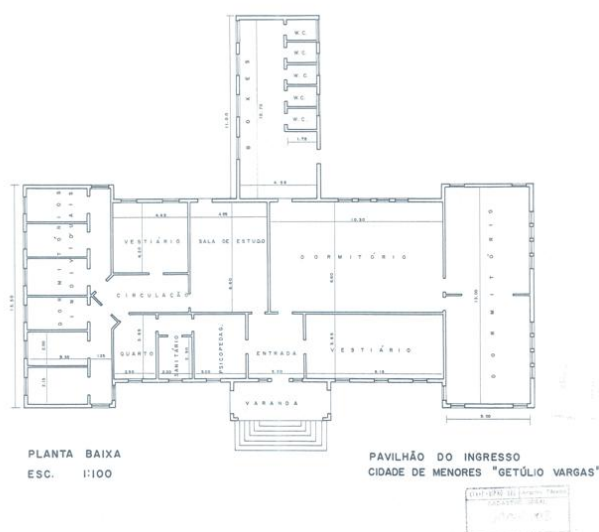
Planta Baixa do Pavilhão do Ingresso, na Cidade de Menores¹⁰²⁷
